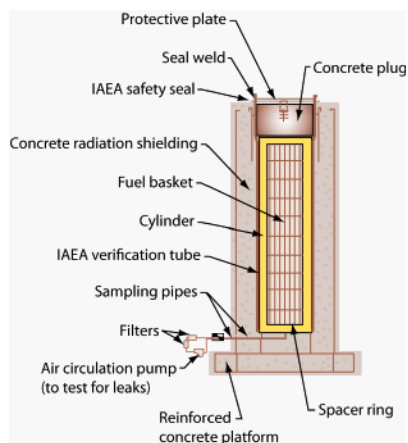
Konstruktion av "Dry Storage containers" (DSC). Bild från /OPG 2004/. Källa: Ontario Power Generation Inc.
